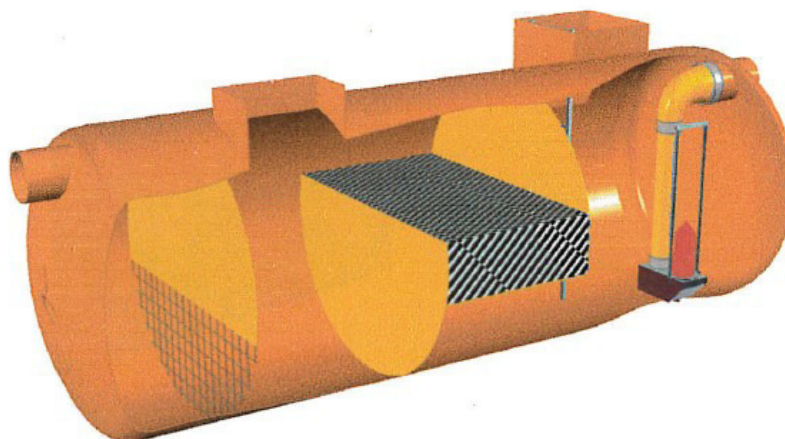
impianto di pretrattamento di sedimentazione disoleazione (vista in sezione)
